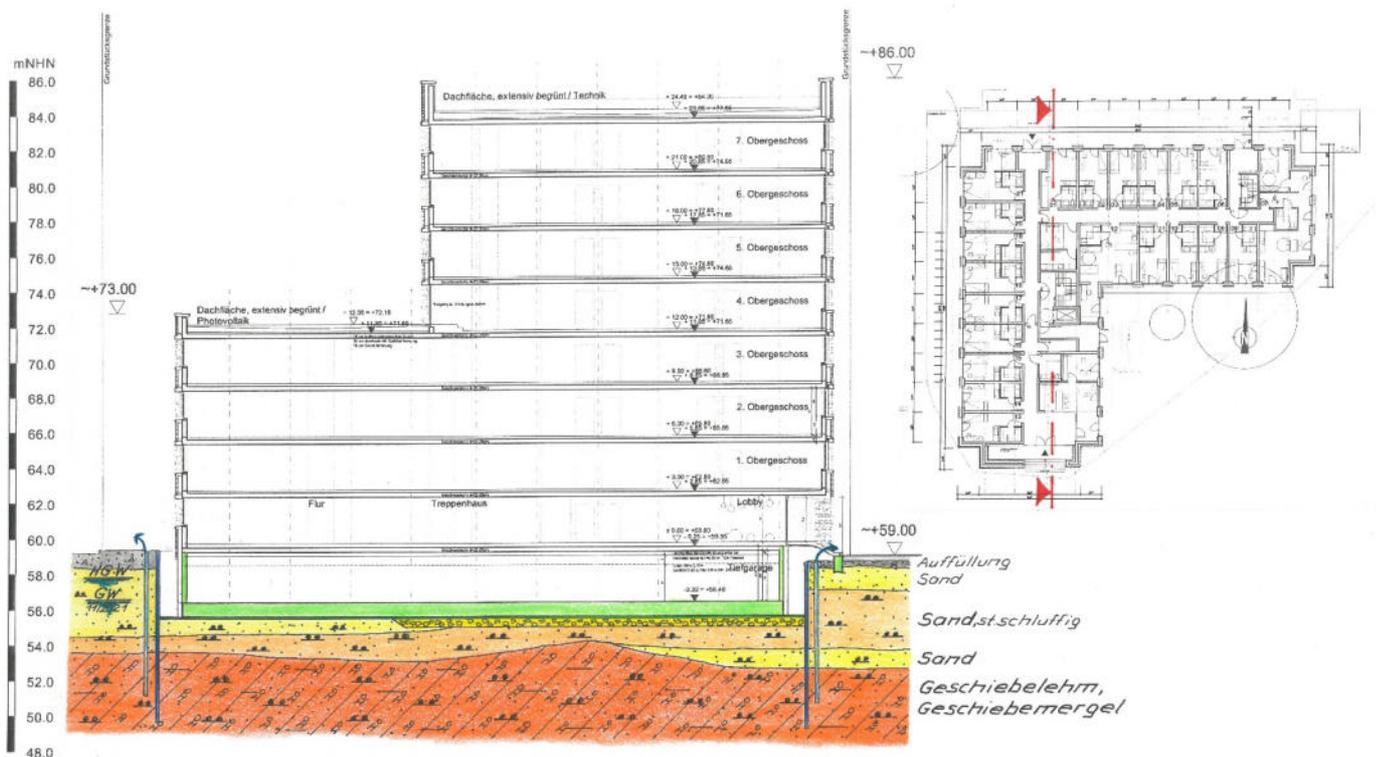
prinzipieller Längsschnitt mit dem schematischen Baugrundaufbau und der Gründung sowie einem Lageplan mit der Schnittführung
